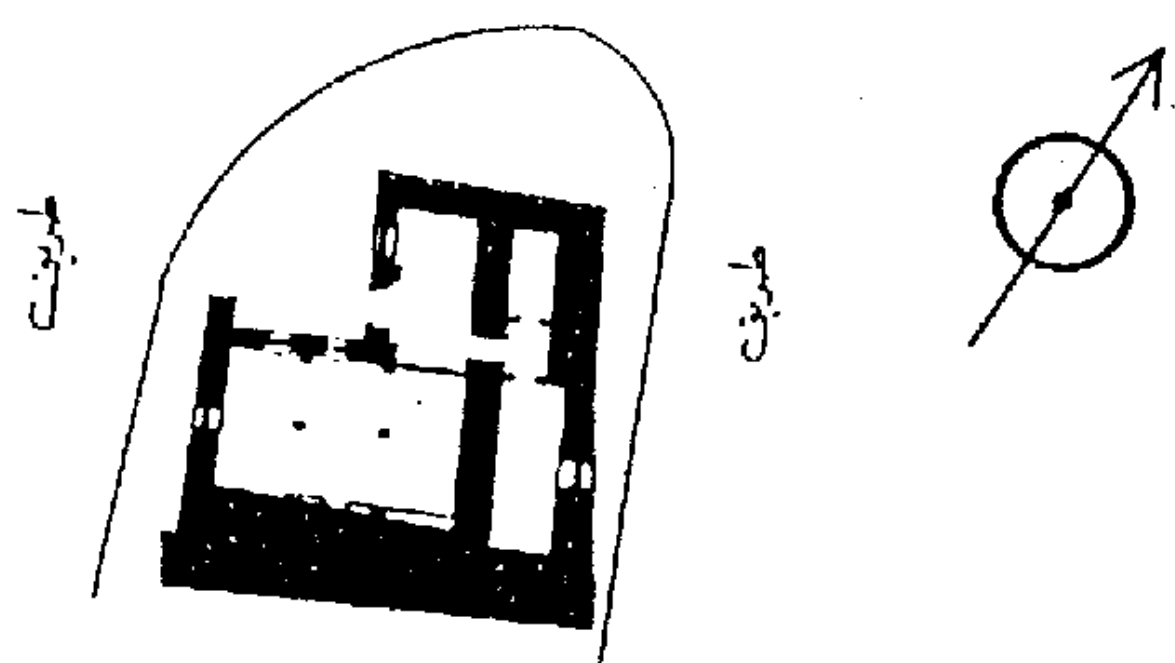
مسقط أفقي لجامع الناقة عن الموسوعة (الجزء الأول).
